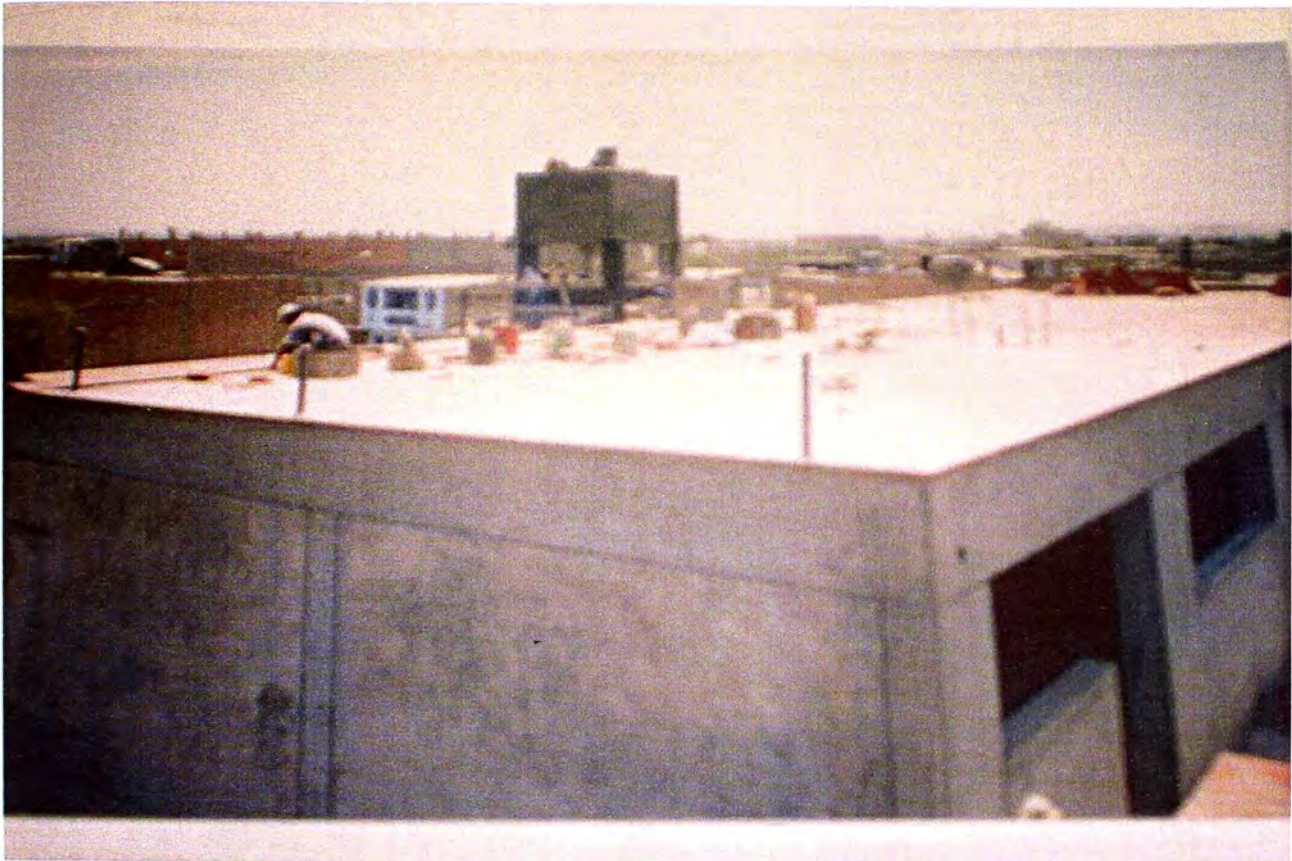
VISTA DE MUROS TARRAJEADOS EN SS.HH.
